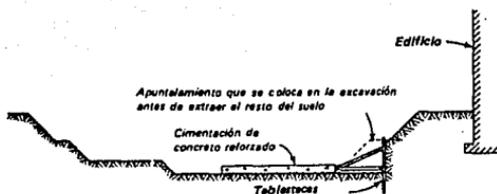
APUNTALAMIENTO TÍPICO EN EXCAVACIONES ANCHAS Y PROFUNDAS
